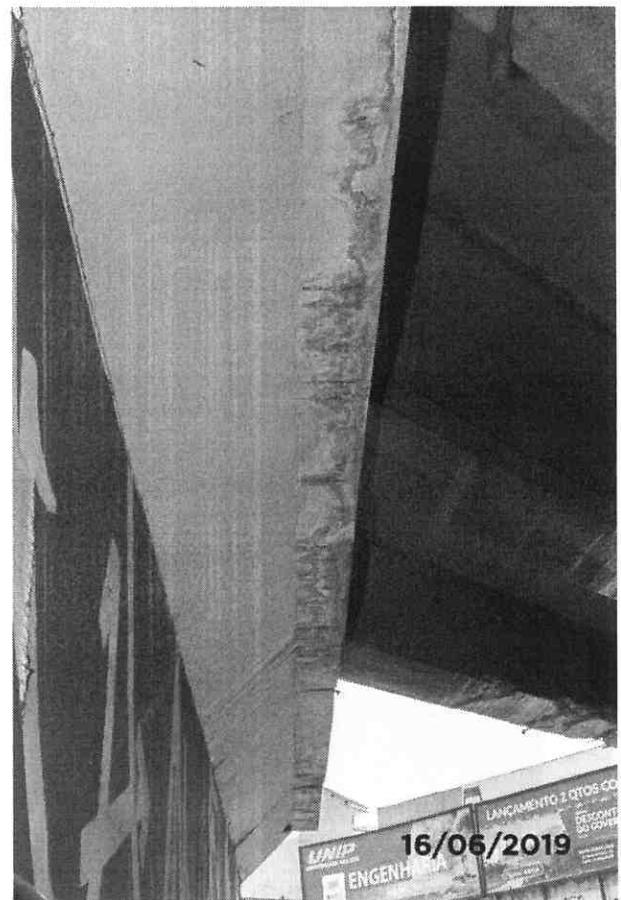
Armadura exposta na viga de travamento transversal sobre os pilares centrais.
